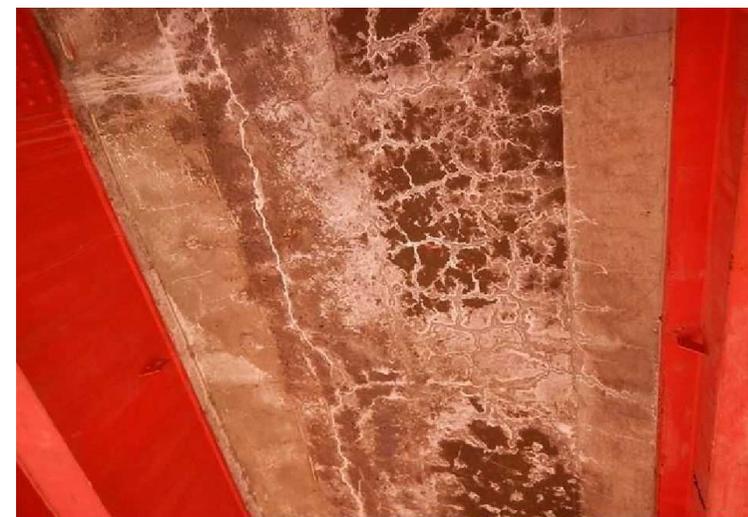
コンクリートのひび割れ、遊離石灰の漏出
